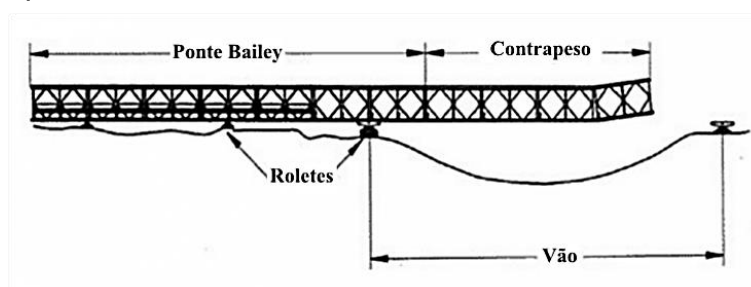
Vista longitudinal da ponte lançada sobre o vão
